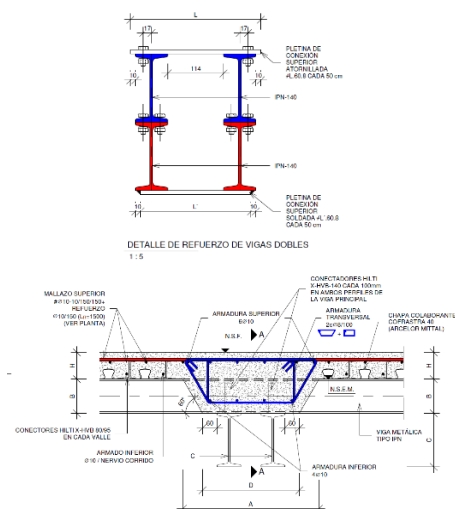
Detalles de refuerzo de dinteles recogidos en fase de proyecto
